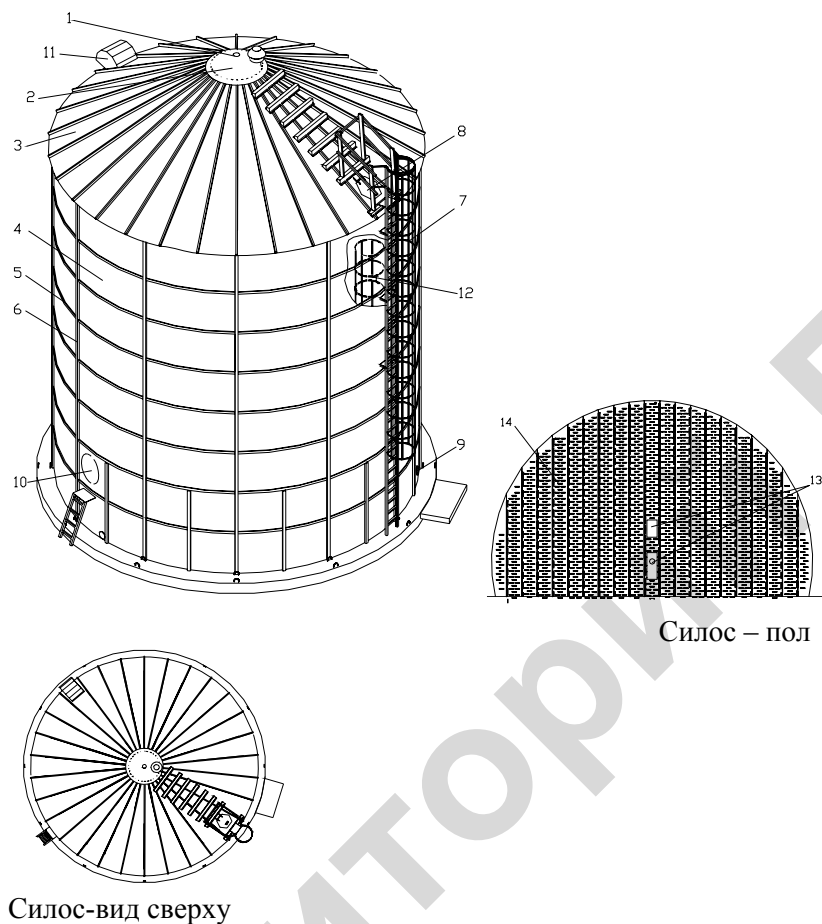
Конструкция силоса SPA со стандартным оснащением:
